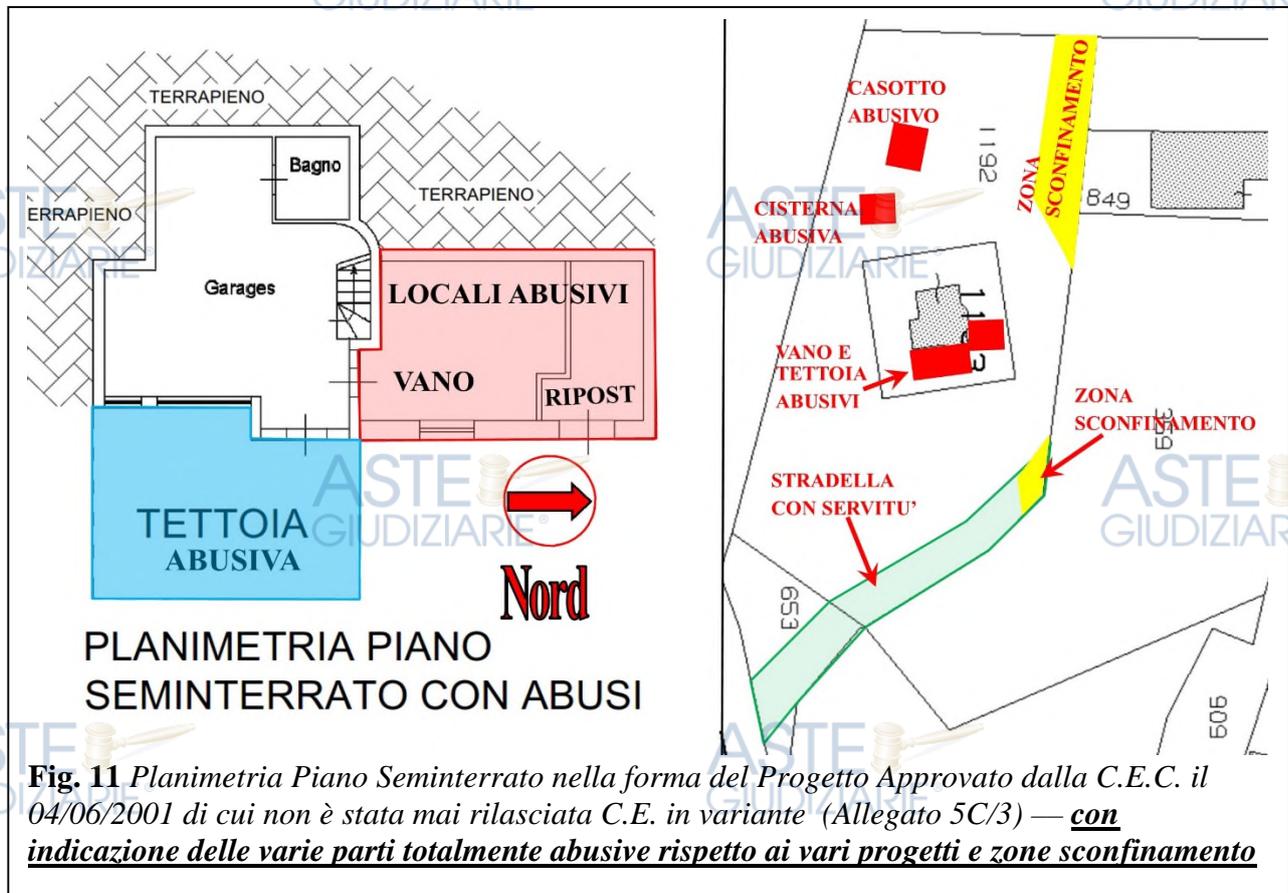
Planimetria Piano Seminterrato nella forma del Progetto Approvato dalla C.E.C. il 04/06/2001 di cui non è stata mai rilasciata C.E. in variante (Allegato 5C/3) — con indicazione delle varie parti totalmente abusive rispetto ai vari progetti e zone sconfinamento
